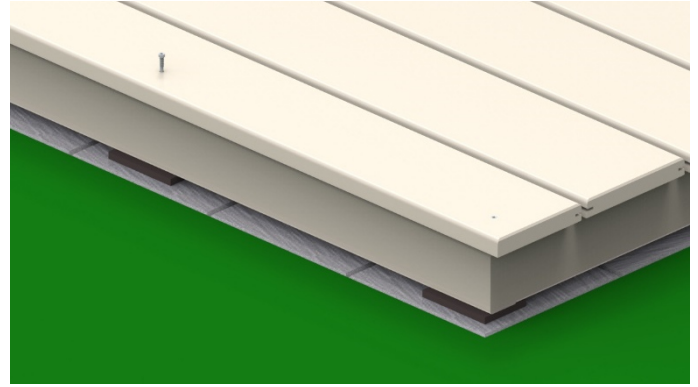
Schieben Sie die abgeschnittene Terrassendiele mit der Nutseite auf die RASK-Clipse. Anschließend wird die Diele mit einer Terrassenschraube min. 5 x 60 V2A alle 50 cm auf der Unterkonstruktion verschraubt. Die Schrauben sollten gleichmäßig max. 1 mm tief versenkt werden.
